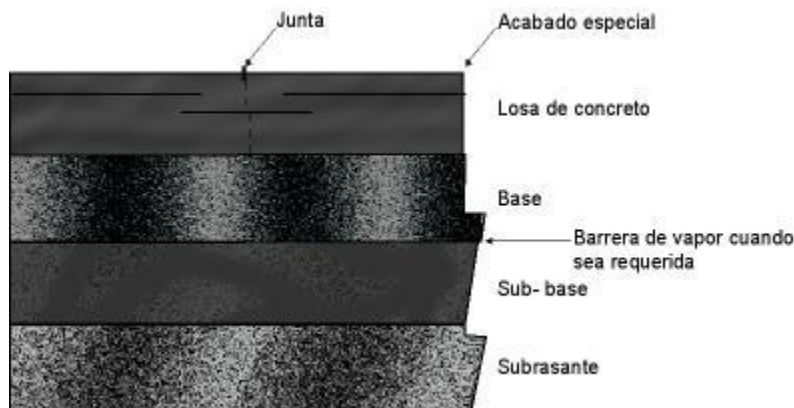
Vista en sección que muestra la relación entre la subrasante, la base y la losa.
